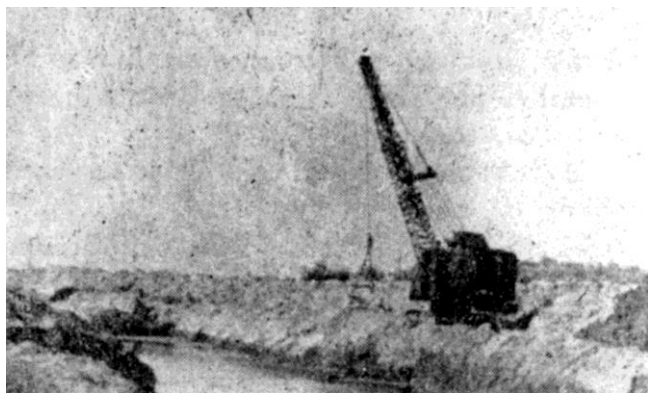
Executare mecanizată a digului pentru amenajare stuficolă în Delta Dunării
